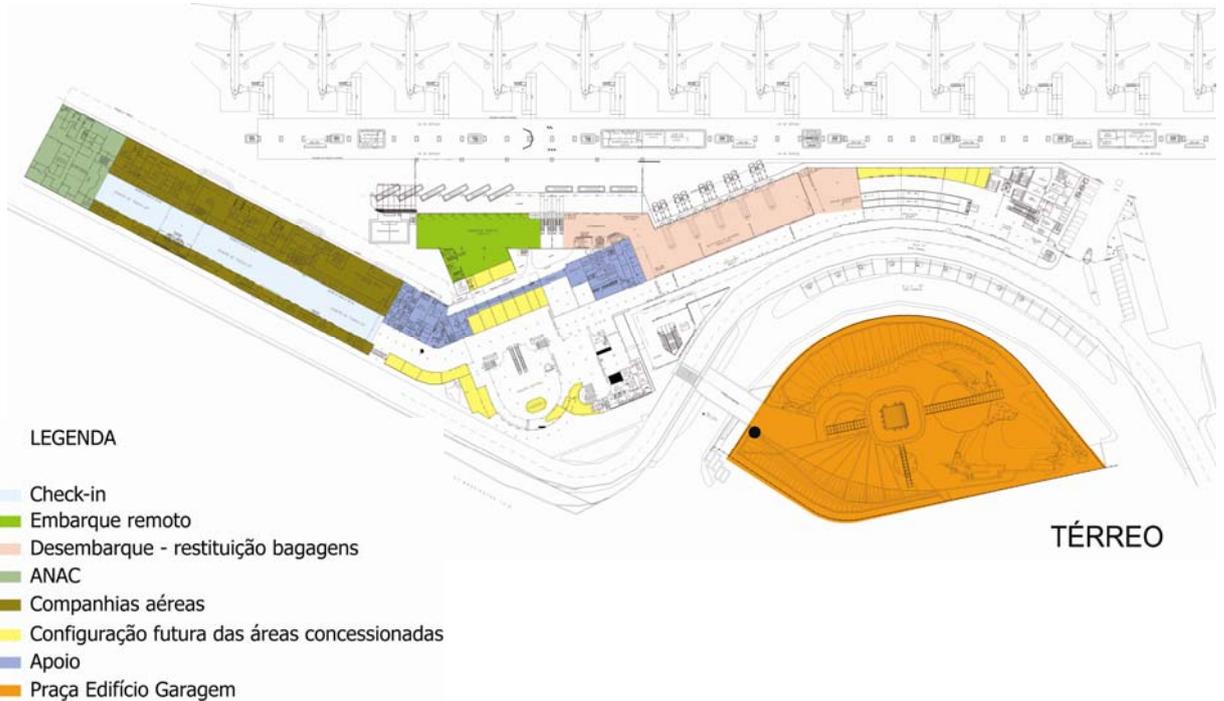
Planta do Térreo. Fonte: INFRAERO, 2008.
